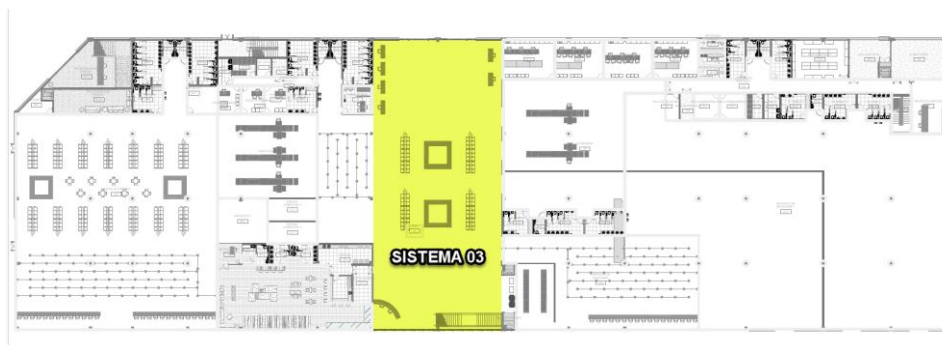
Sistema 03 (Pavimento Térreo – Lado Oeste)
